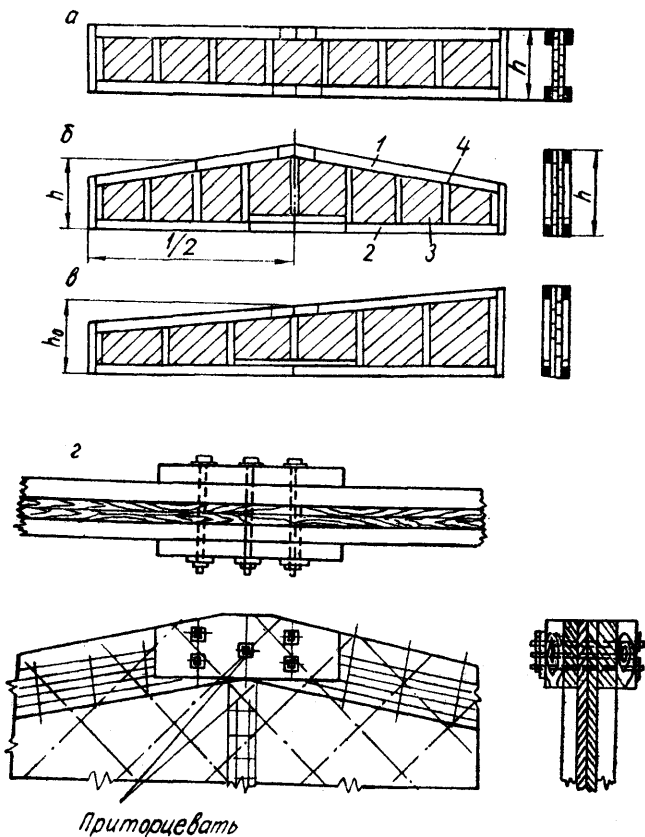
Двугавровые гвоздевые балки с перекрестной стенкой:
